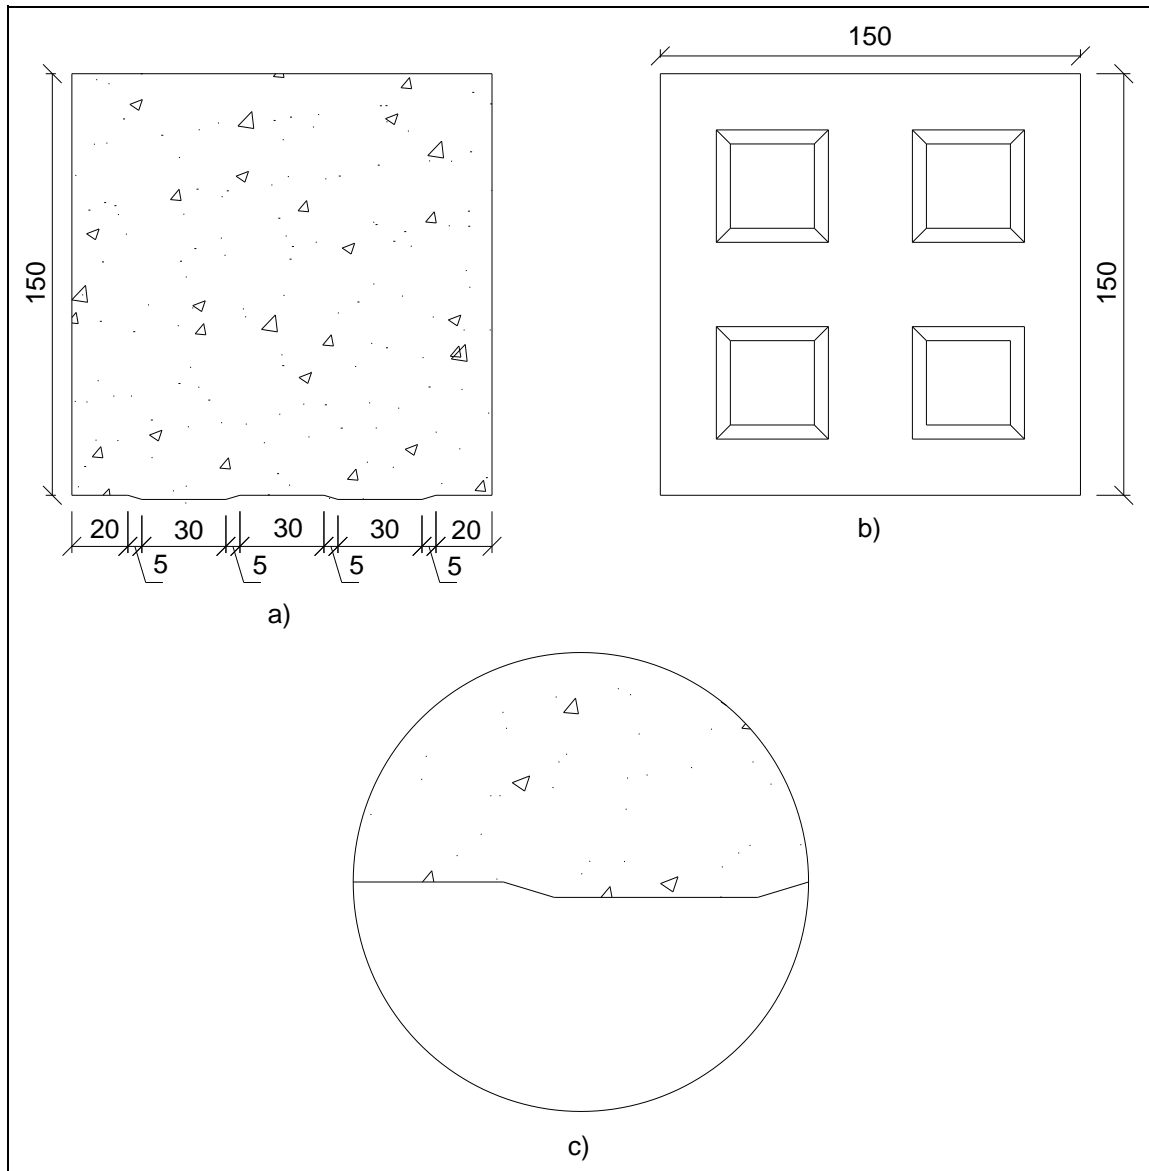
Detalhe do bloco de concreto com quatro saliências (dimensões em mm) (EL DEBS et al., 2008): a) Vista lateral; b) Vista da face rugosa; c) Detalhe da saliência do bloco
